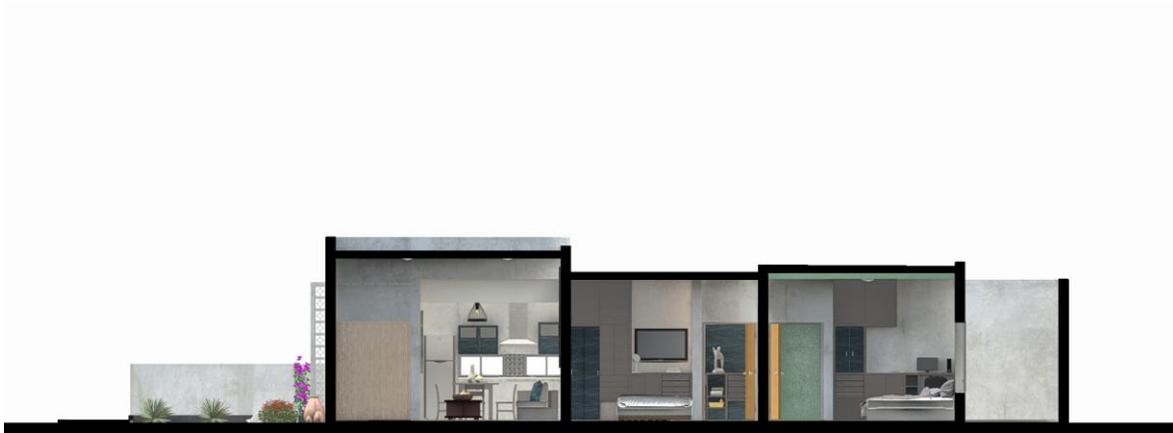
Corte longitudinal. S/E. Fuente: Elaboración propia.
